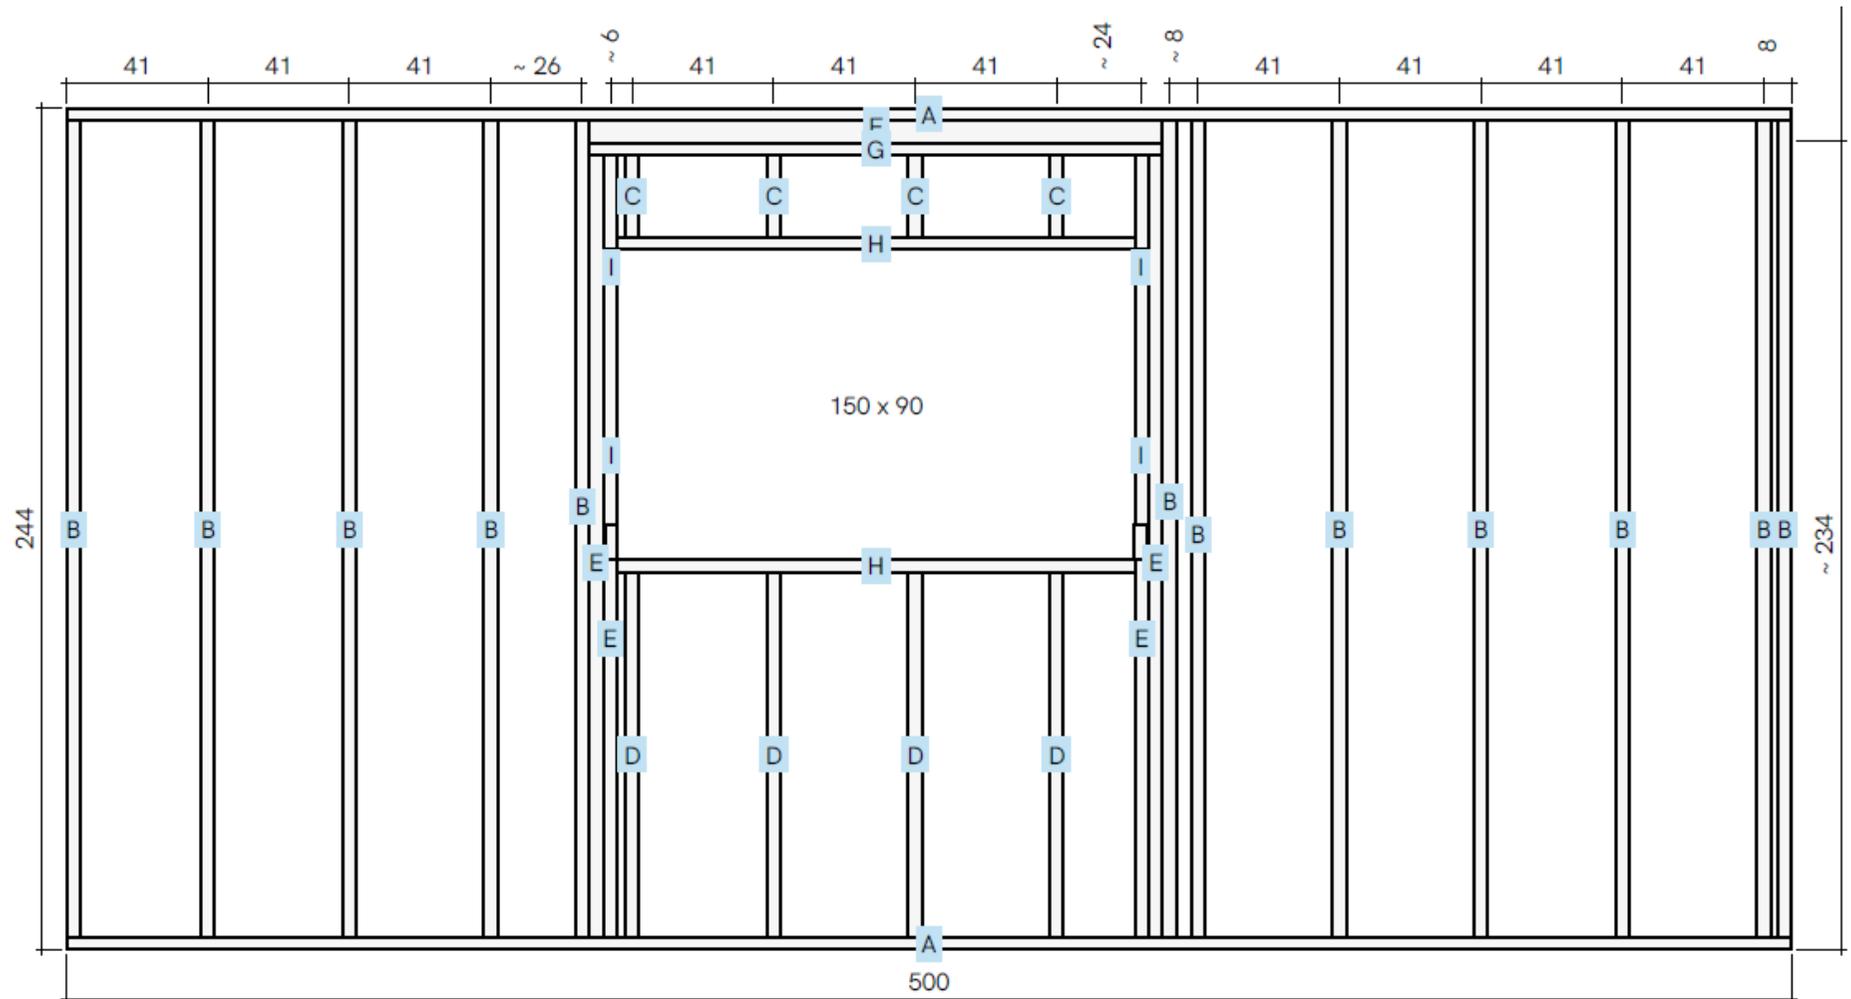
Andino, E. (2020)*. Diseño de paneles típicos para obra en steel frame, para ensamblaje o construcción en obra con detalle de vano de ventana. Elaboración propia.
